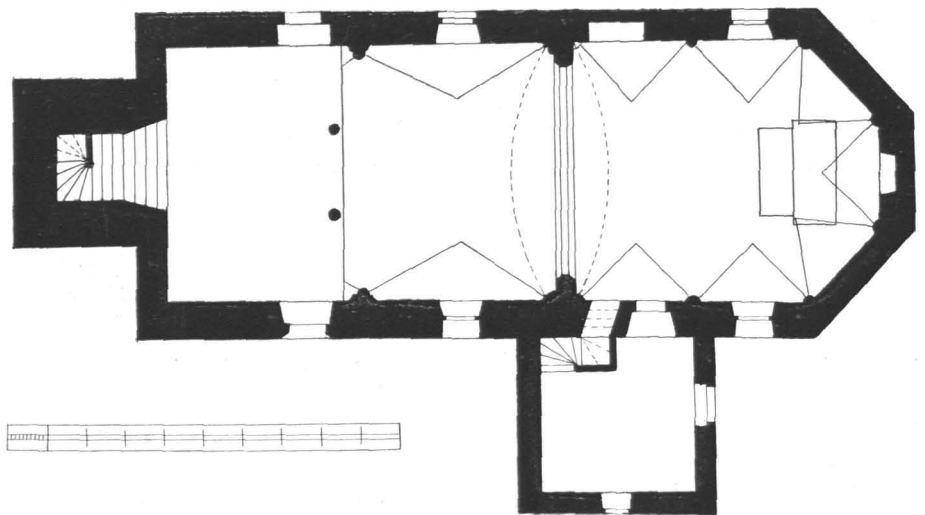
Sommerholz, Filialkirche, Grundriß 1:200 (S. 164)
